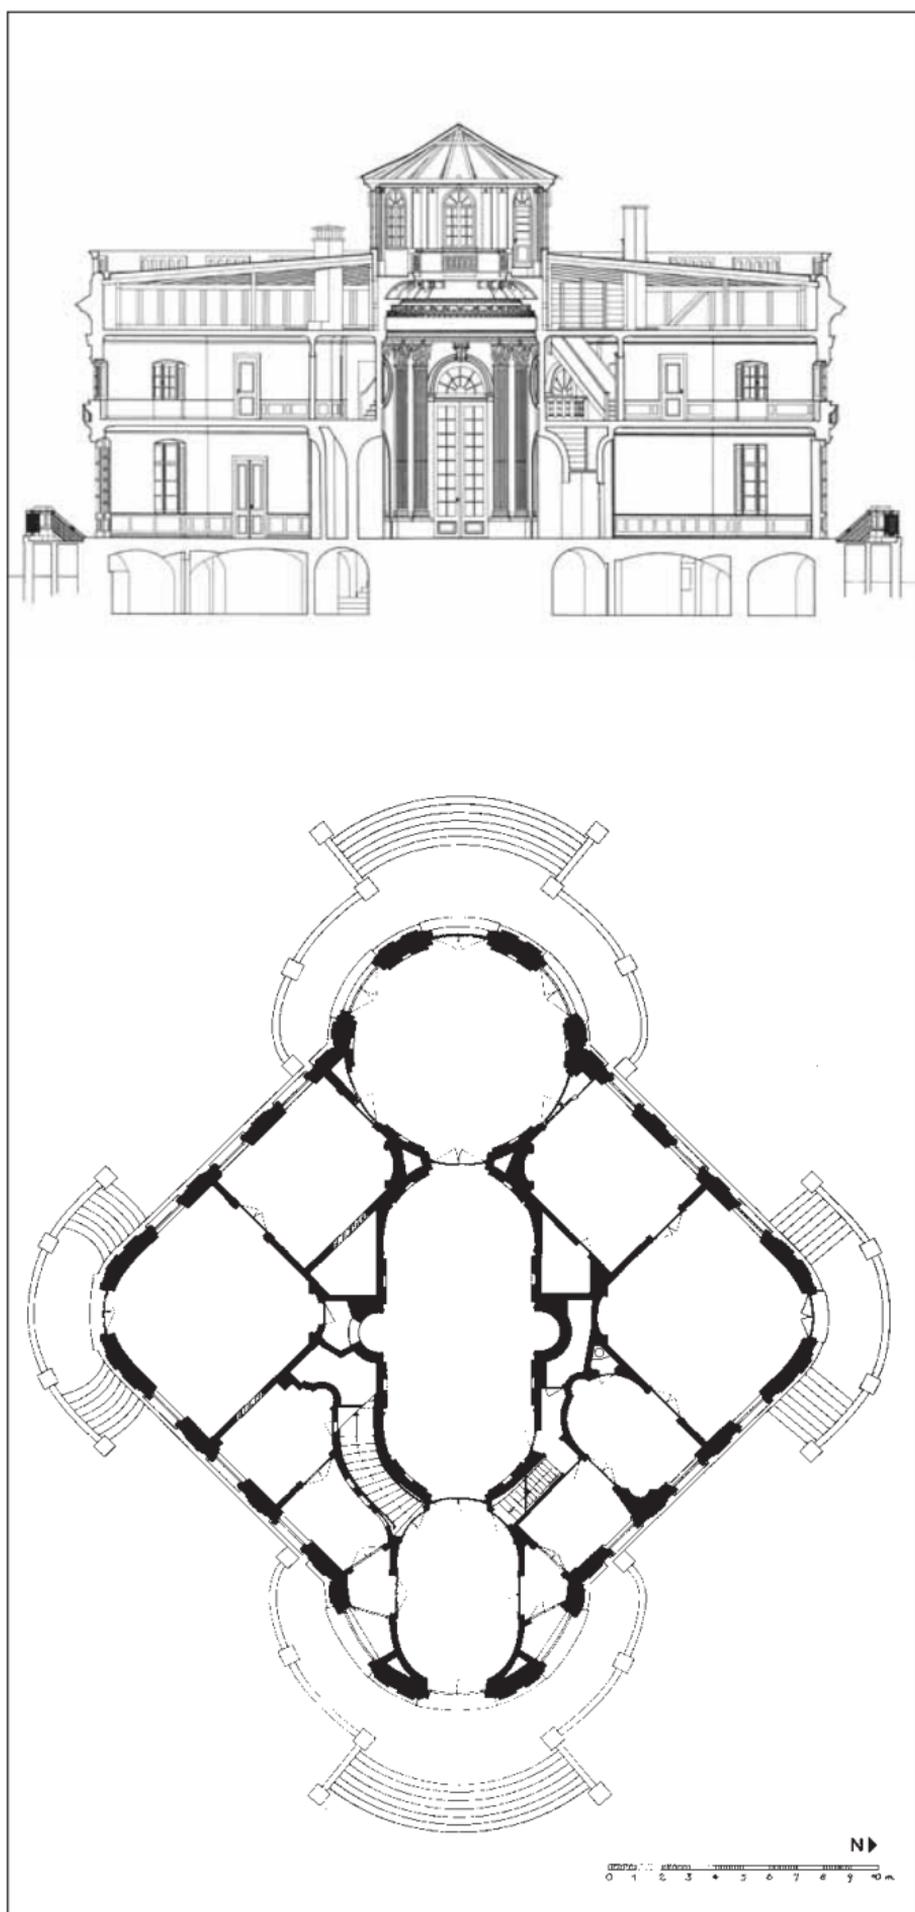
Querschnitt Nord-Süd Richtung, Grundriss Erdgeschoss
